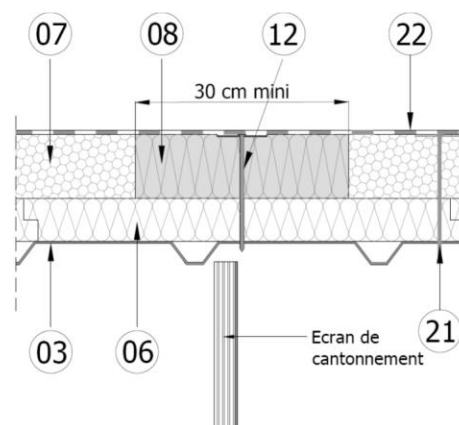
Exemple de recouvrement au droit d'un écran de cantonnement
